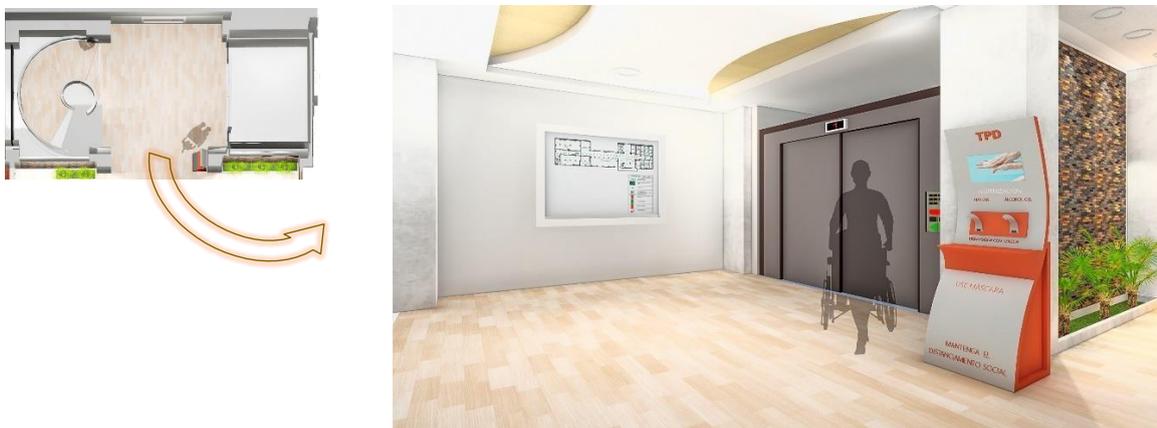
Propuesta de Diseño del Pabellón de Planta Alta.
